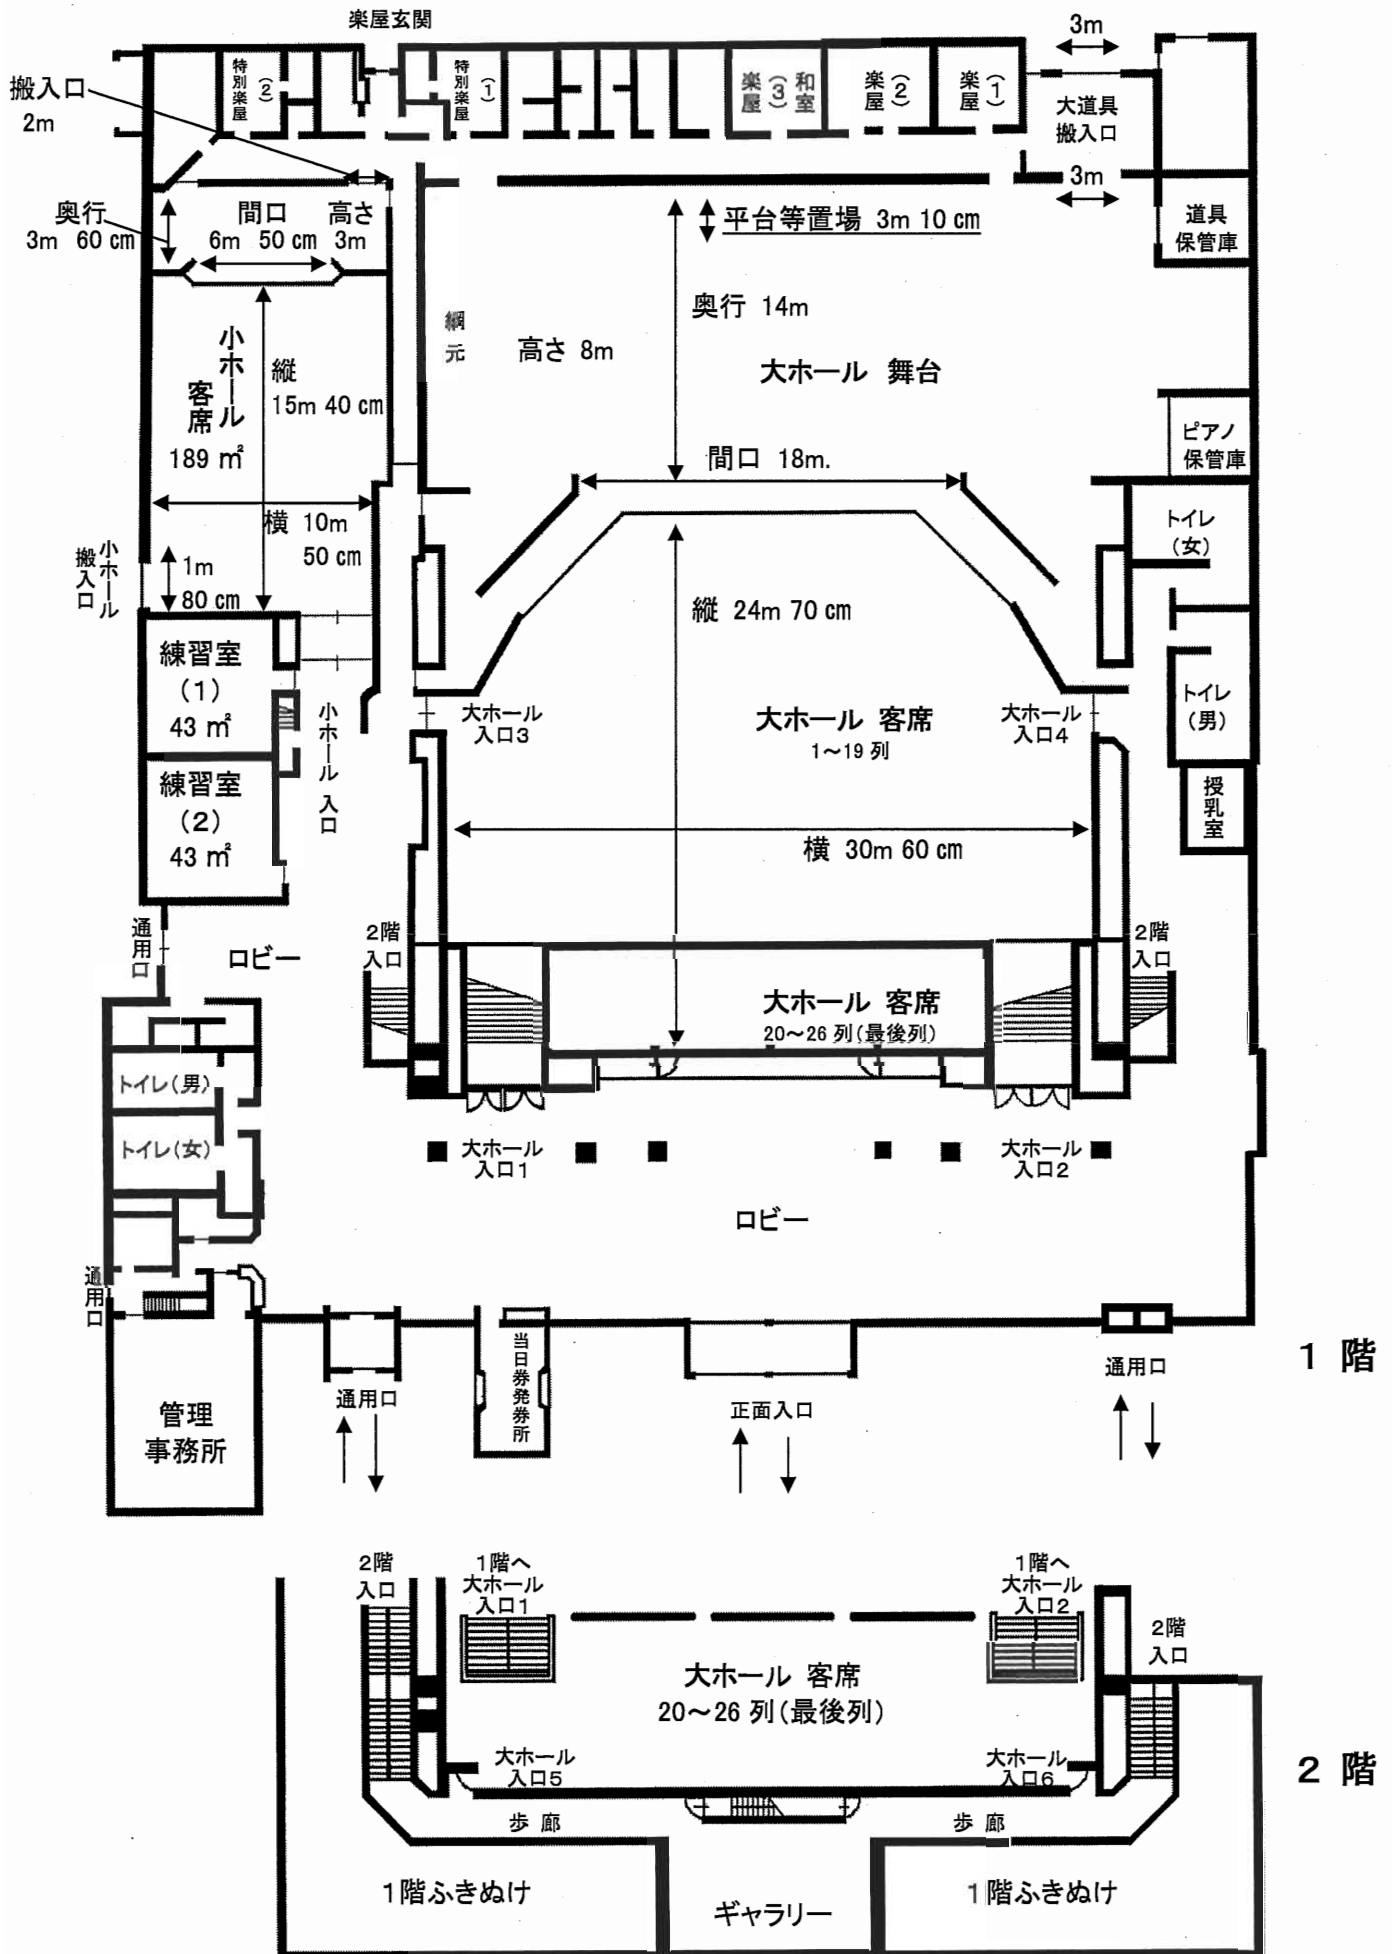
伊佐市文化会館 大ホール 舞台平面図 (マス目有)
